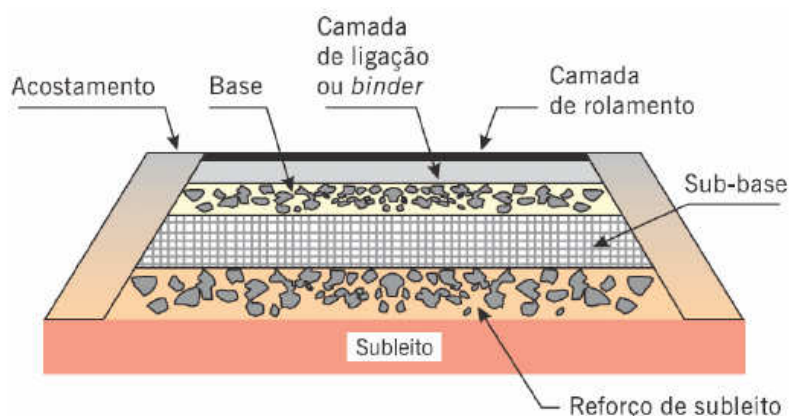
Pavimento flexível (Bianchi, Brito, Castro)
